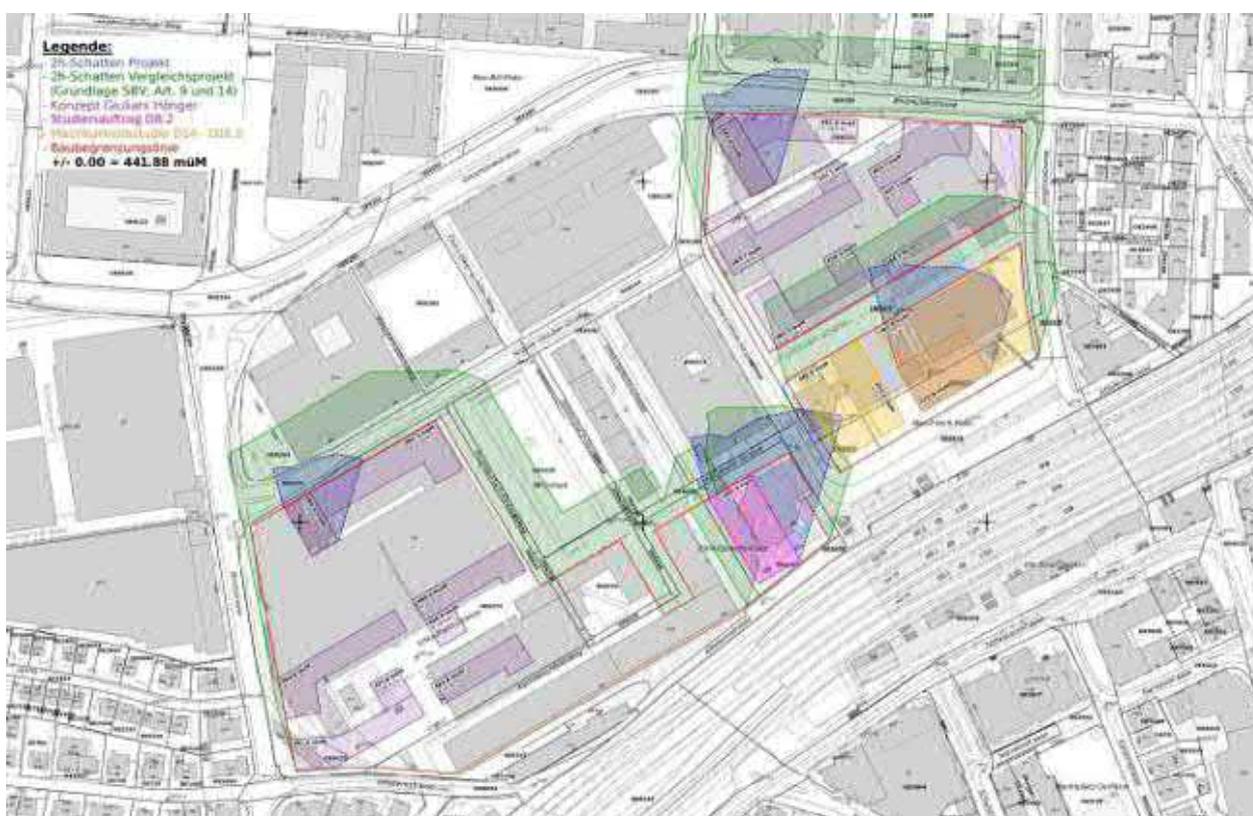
3-Stunden-Schattenplan bei Bebauung nach Masterplan (Stadt Zürich Geomatik + Vermessung, 12.06.2020)
